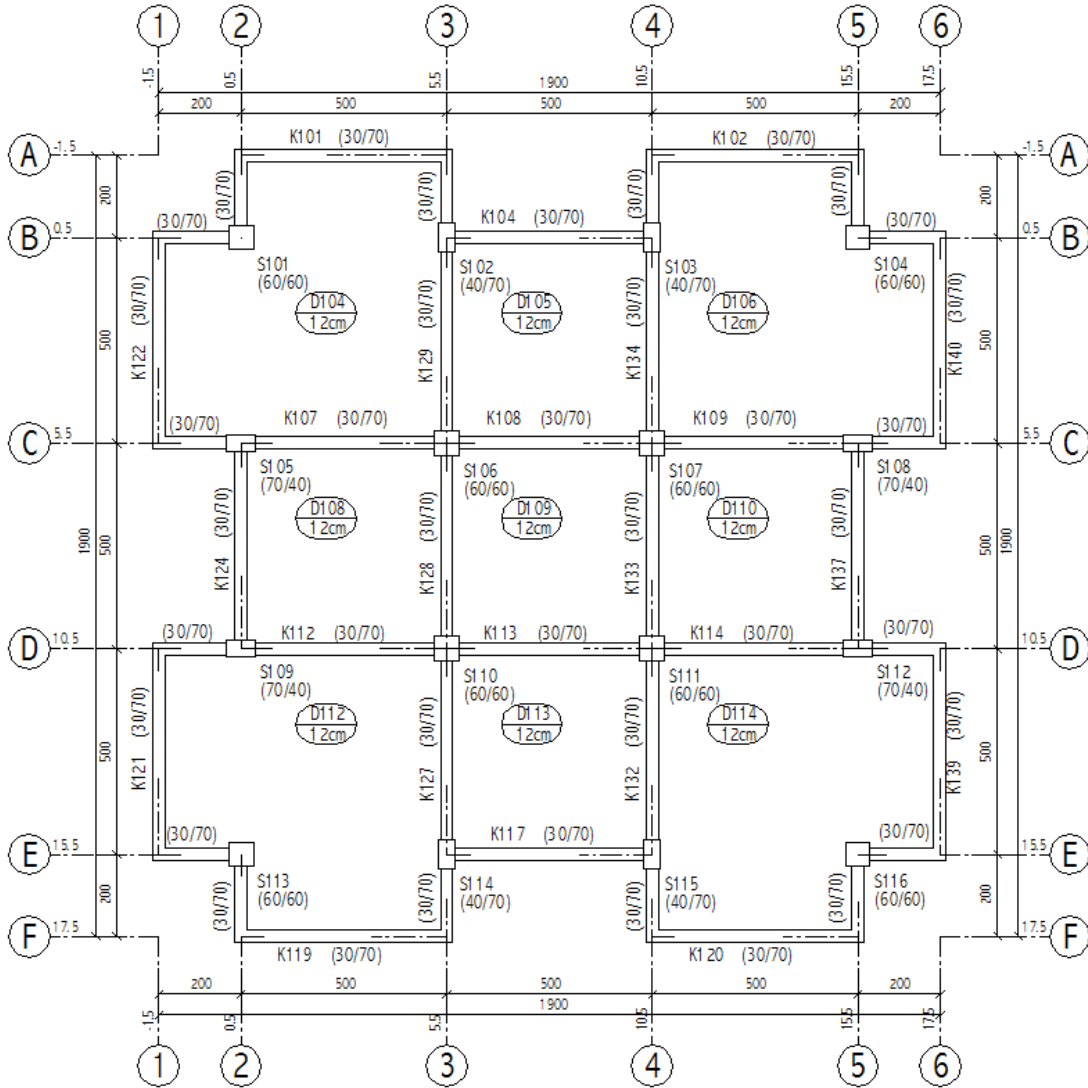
Bina A 10 katlı basık kirişli plan bilgisi
